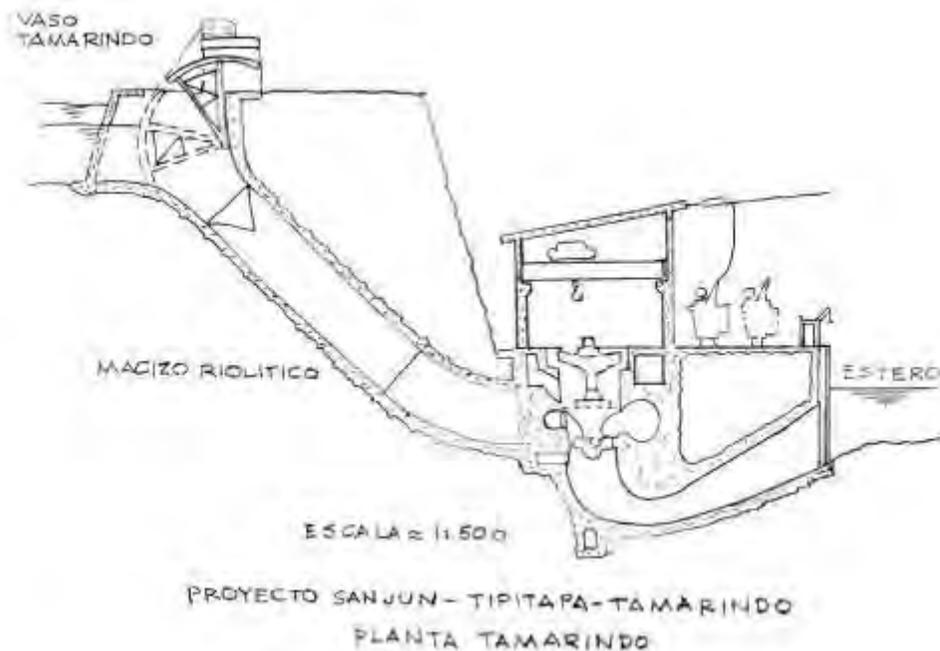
Sección de la planta hidroeléctrica de 115 MW El Tamarindo
